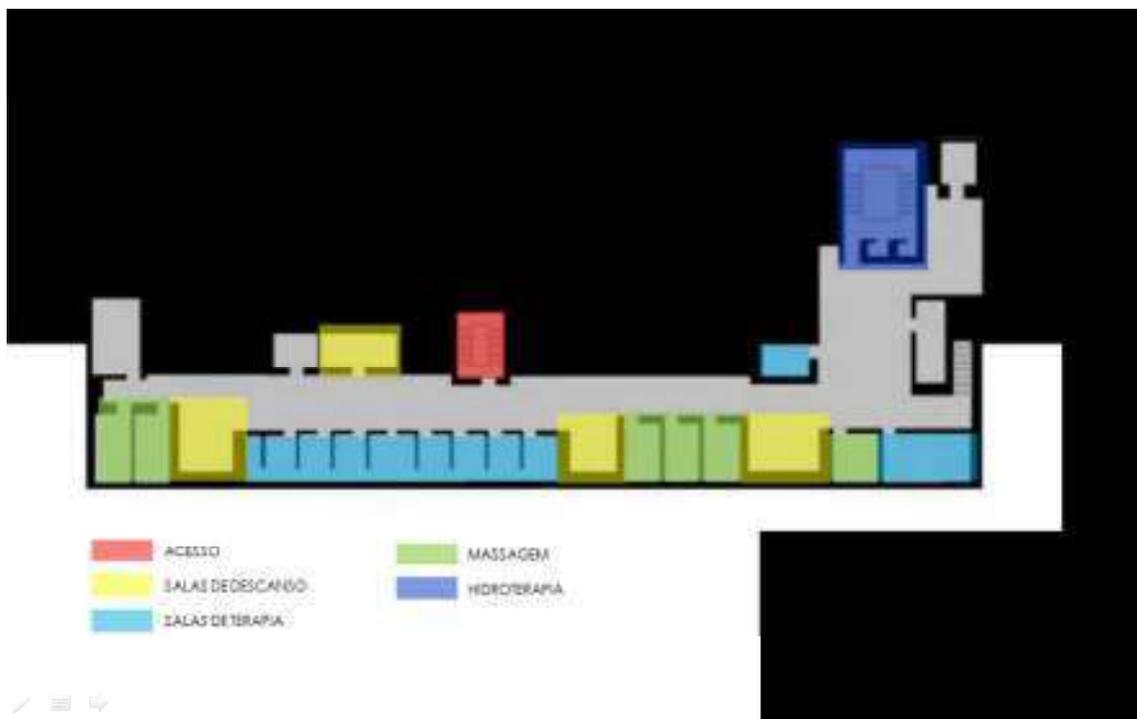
DIAGRAMA DA PLANTA DO PAVIMENTO TÉCNICO DO SPA
